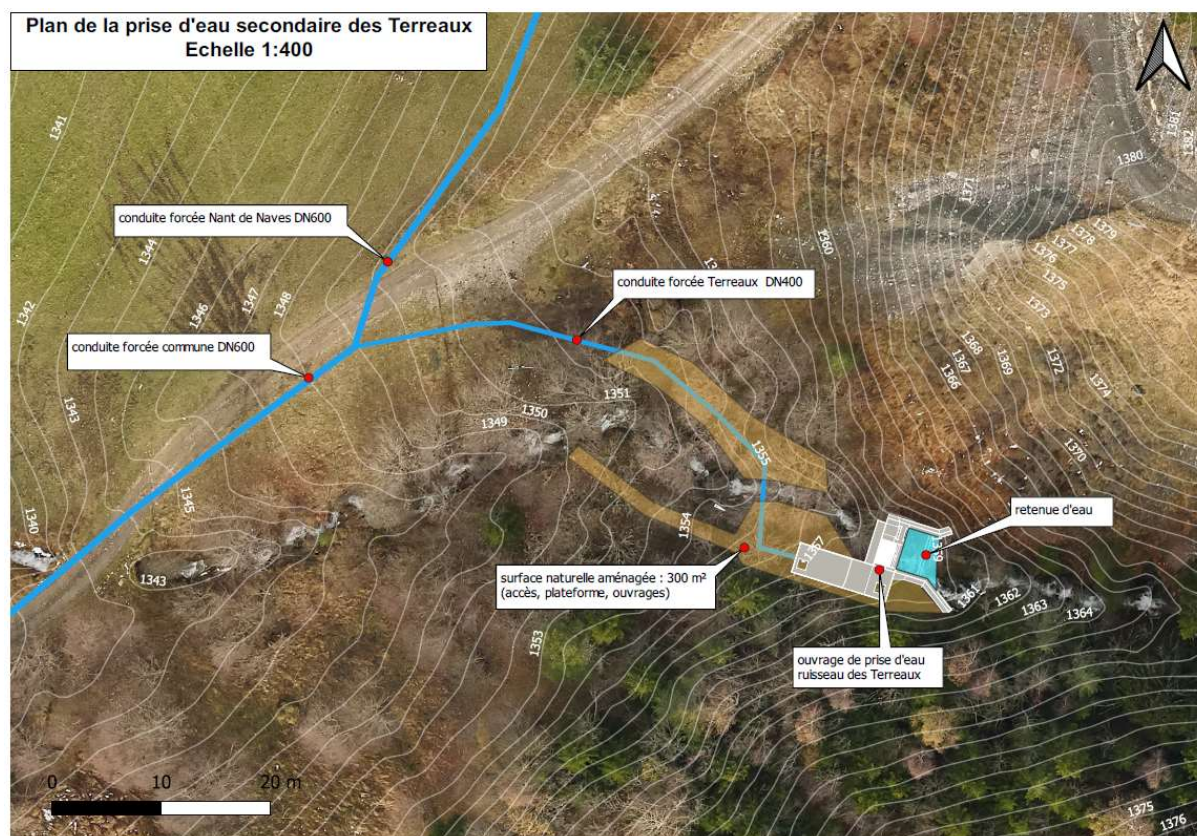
plan de masse au 1 :400 de la prise d'eau secondaire
